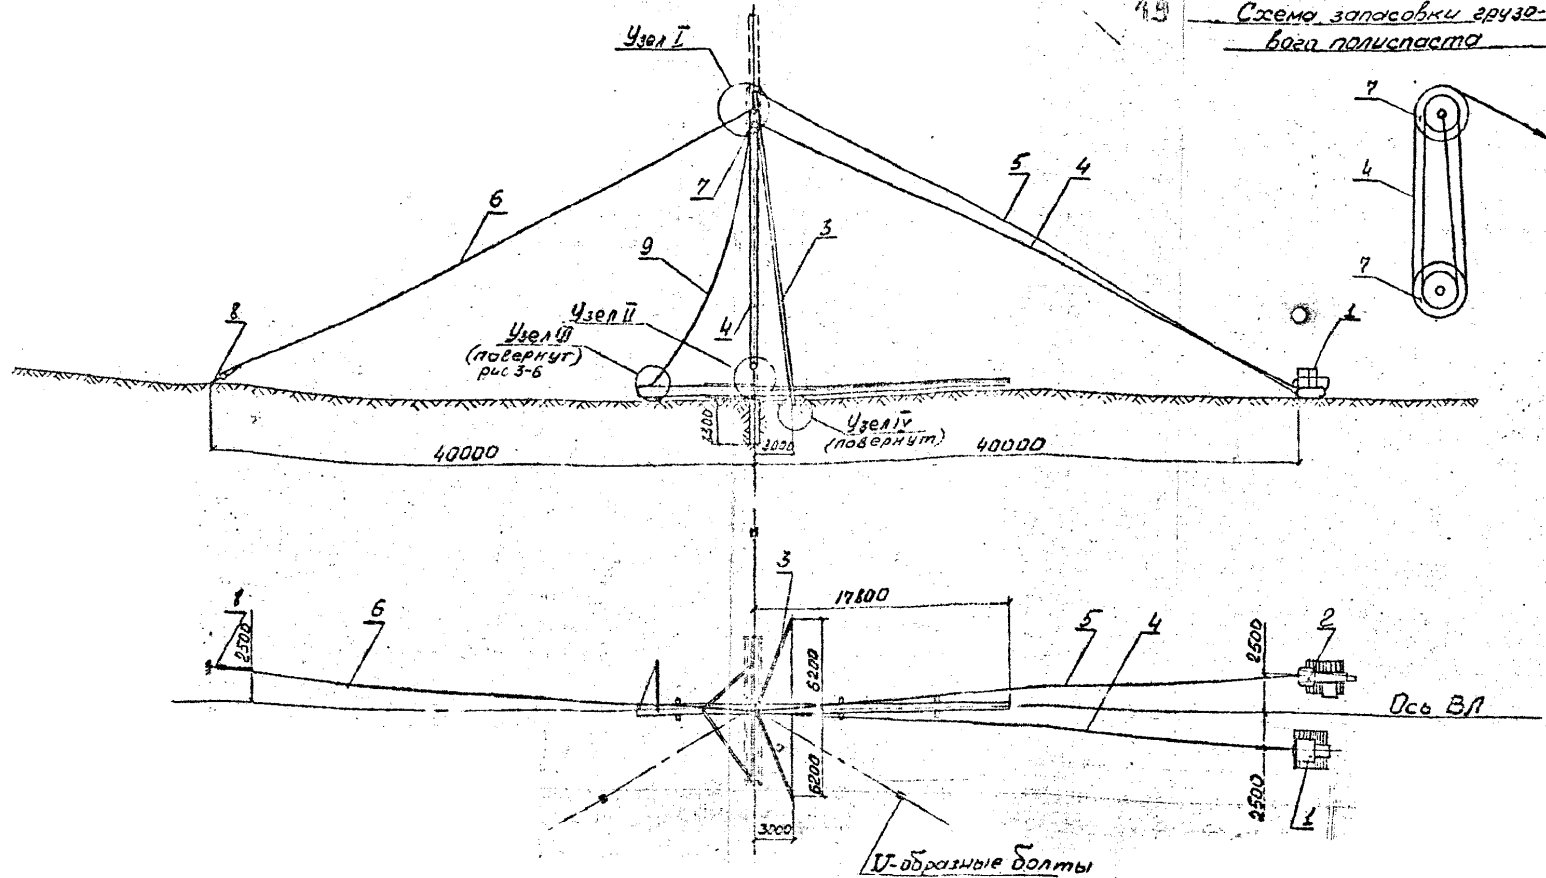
Система подъема анкерно-угловых железобетонных опор
